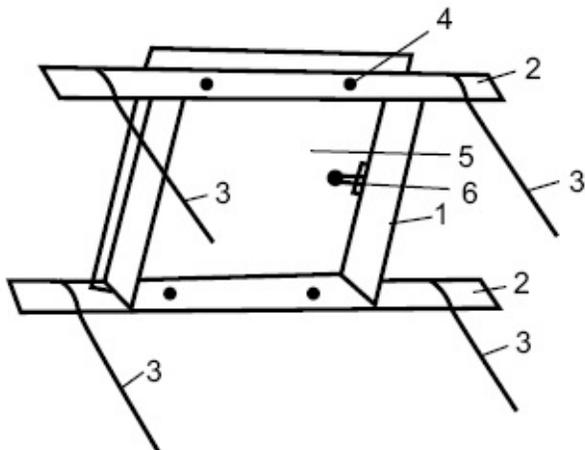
Способы крепления дверок: 1 – рамка дверки; 2 – кляммер; 3 – проволока никромовая; 4 – заклепки; 5 – дверка; 6 – защелки дверки
